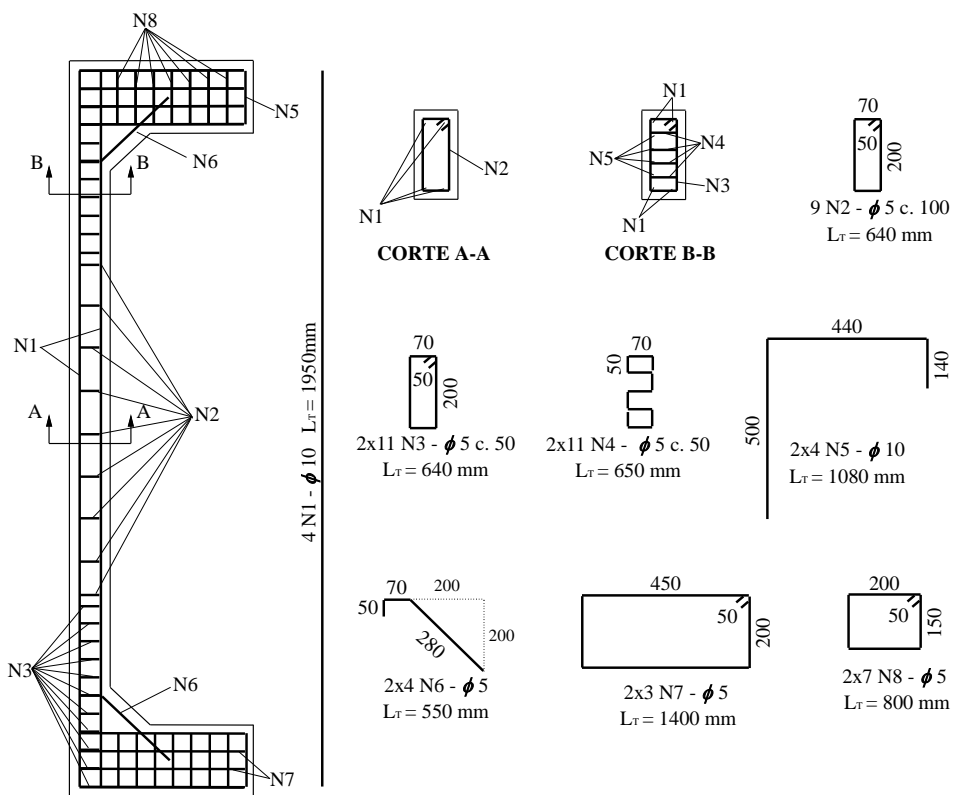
15 - Detalhamento das armaduras dos pilares da série PCA4 (ADORNO, 2004)
